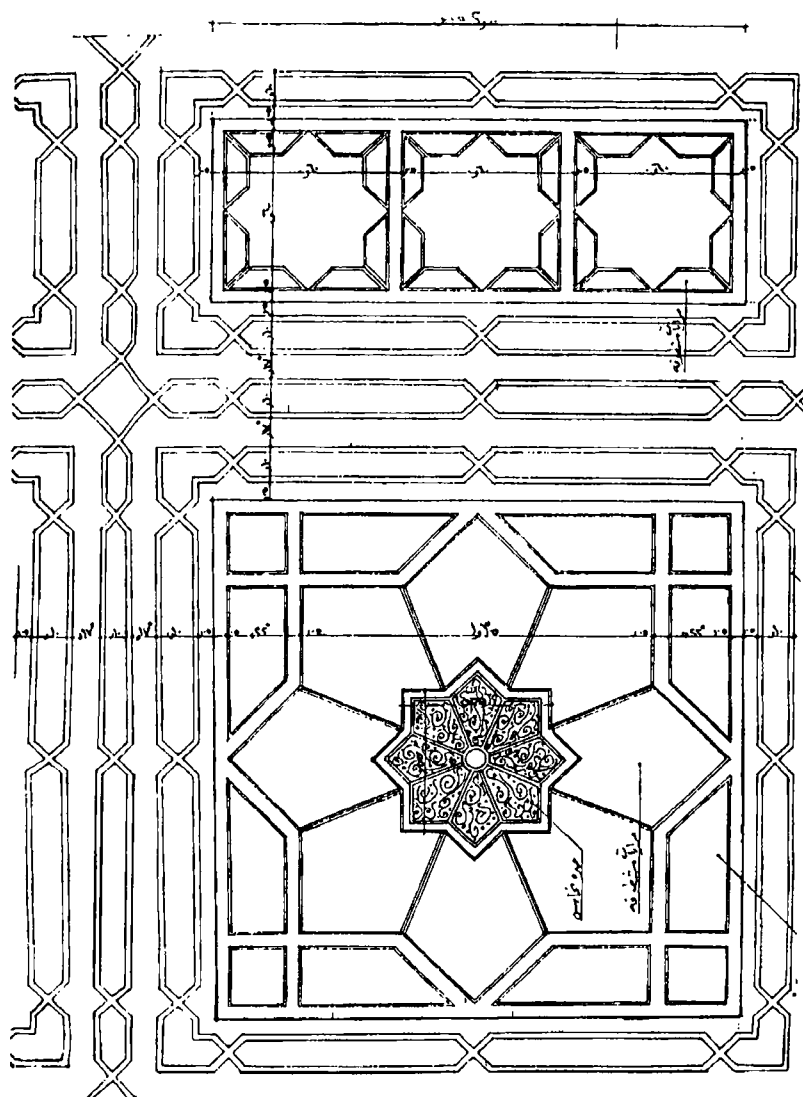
مسقط أفقي لسقف خشبي لحد سياحي بالأقصر (تصميم المؤلف)
